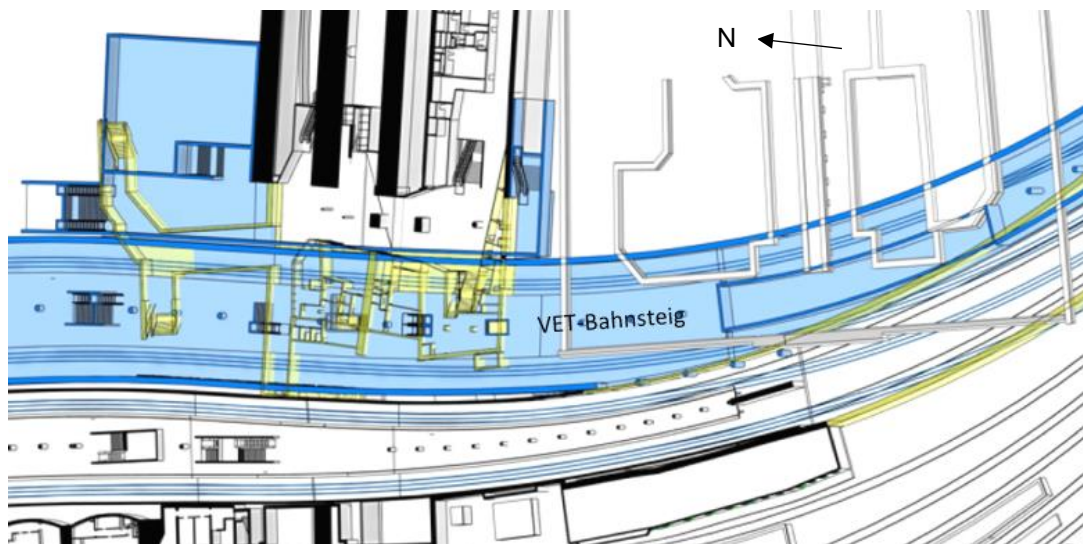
Hbf: Grundriss Bestand Ebene E-1 inkl. VET-Planung [U8]
